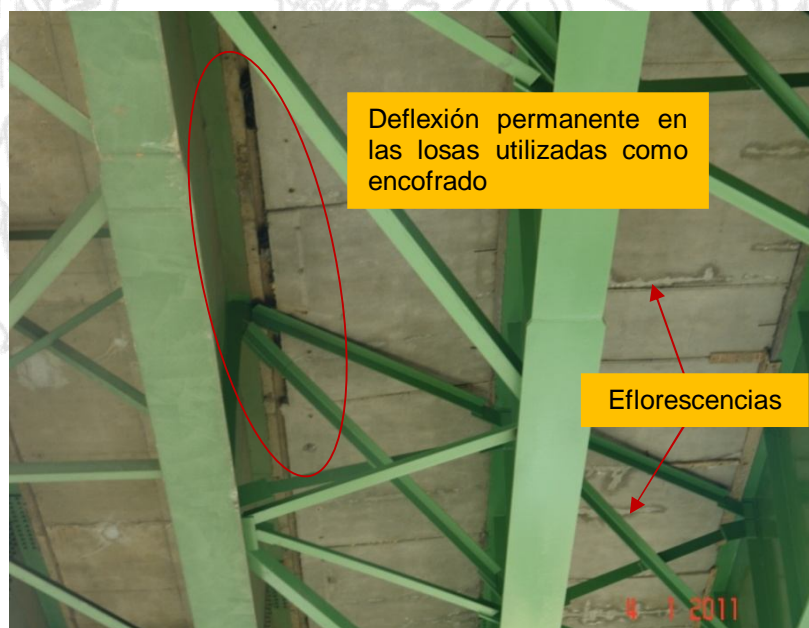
Eflorescencias y deflexiones permanentes en las losas prefabricadas utilizadas en la construcción de la losa de la sección ampliada.
